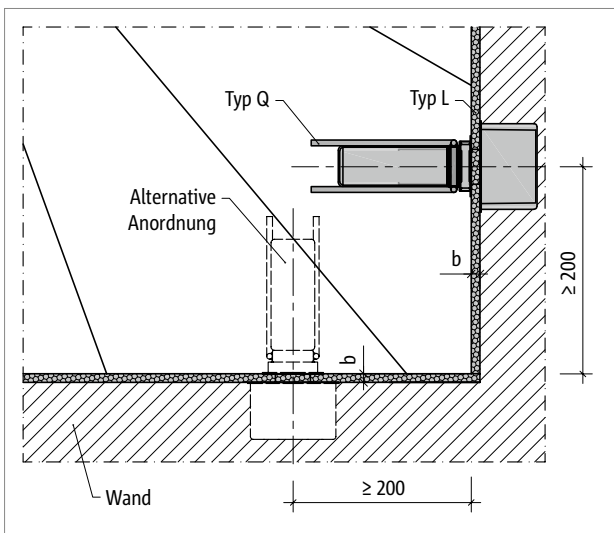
Schöck Tronsole® Typ Q: Elementanordnung, Detail A, Fugenbreite $b = 15 \text{ mm}$ bei Ortbeton, bei Elementtreppenläufen ist die Notwendigkeit einer zusätzlichen Einbautoleranz durch den Planer zu prüfen
